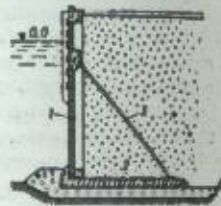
Набережная из сборных железобетонных элементов: 1 — вертикальная стена набережной; 2 — фундаментная плита; 3 — анкерная тяга.
